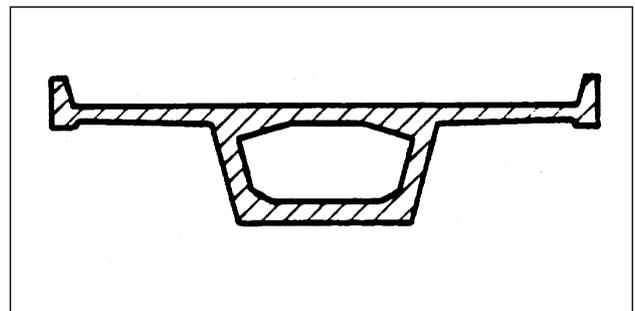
Tipico ponte in cemento armato precompresso per il traffico stradale e ferroviario:
